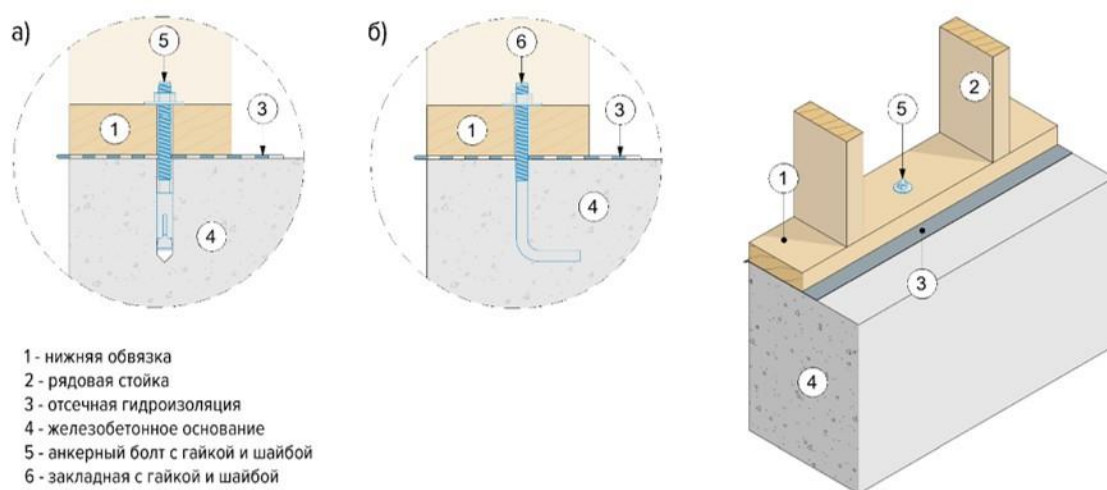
Опираение несущих стен и перегородок на перекрытие
